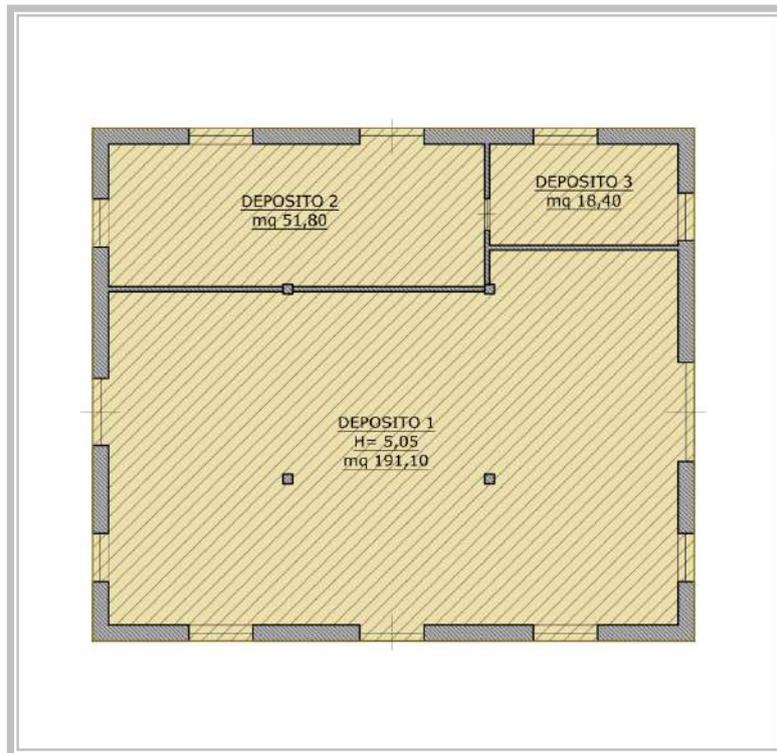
Lotto 10 – Magazzino “Lampante”
